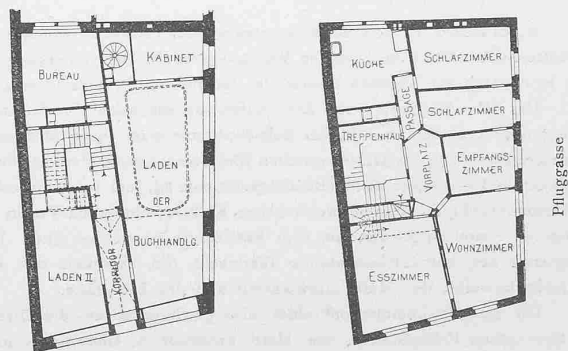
Die Buchhandlung R. Reich. Grundrisse vom Erdgeschoss und II. Stock. — Masstab 1:400.
